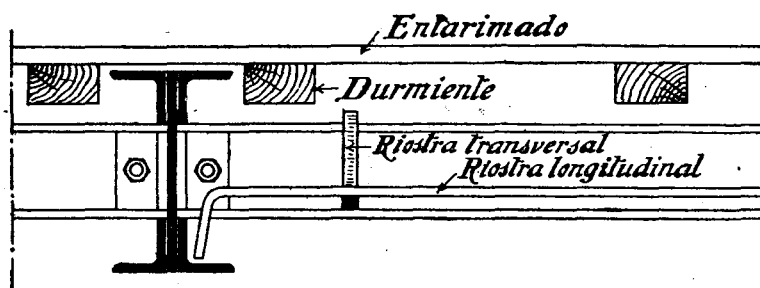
Ensambladura de las viguetas con la viga maestra: caso de un forjado de yesones con piso de entarimado.
